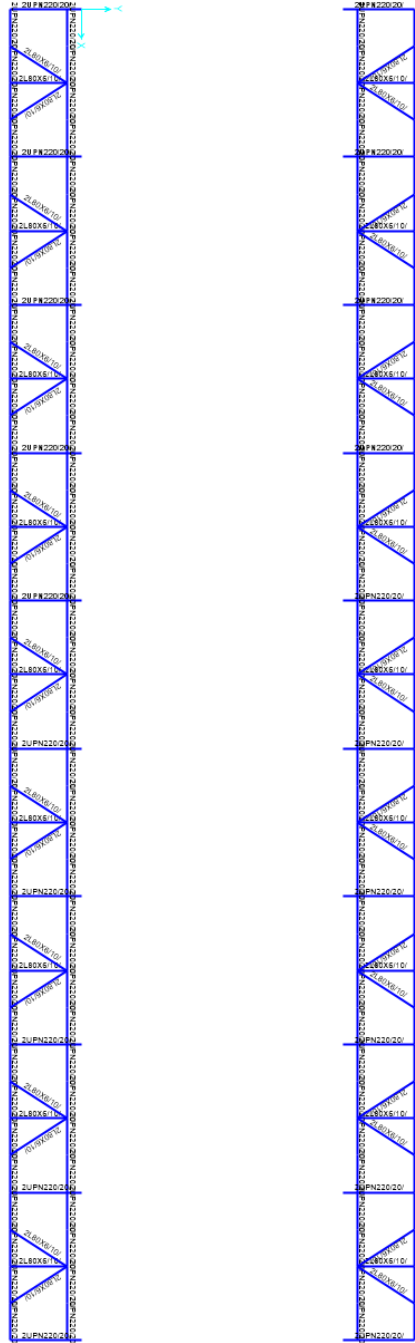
Disposizione dei controventi di piano sugli sbalzi.
